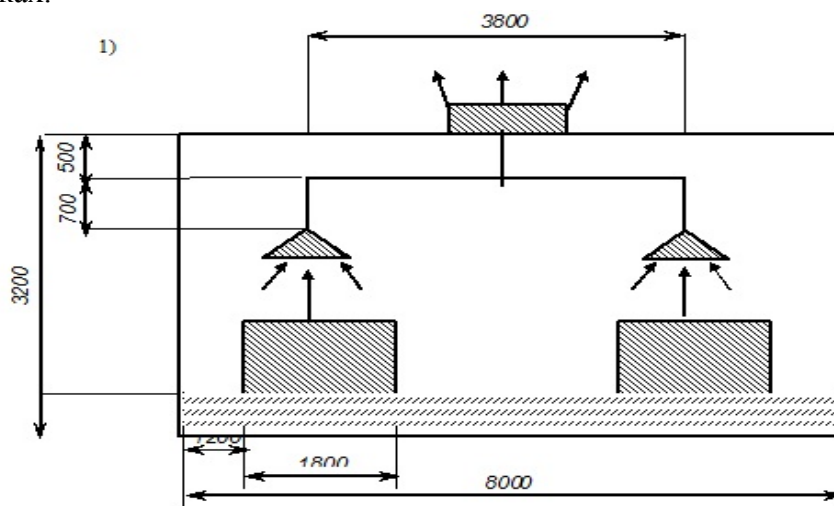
Принципиальная схема воздухообмена вытяжной местной системы вентиляции
